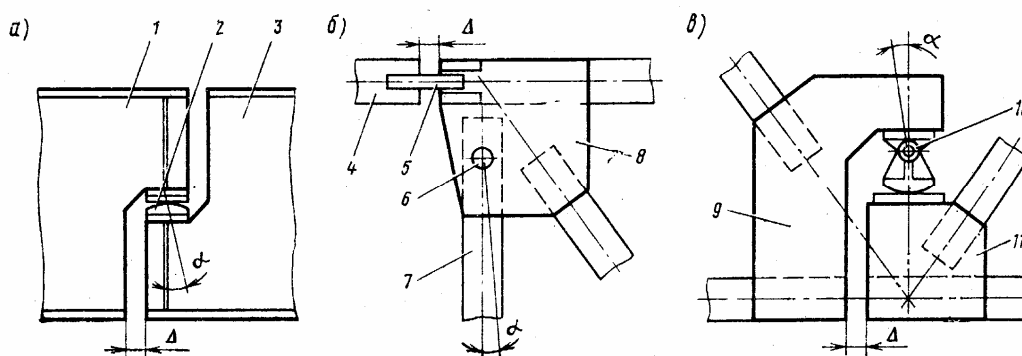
Схемы сопряжения подвесного пролетного строения с консолью
